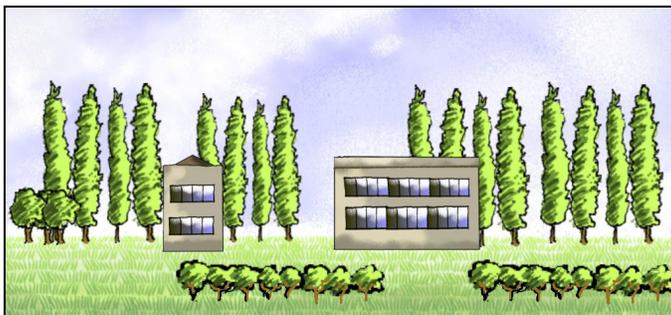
Schema dei prospetti delle tipologie A, B, C ed E: Capannoni+uffici (e/o abitazione) isolati o separati
